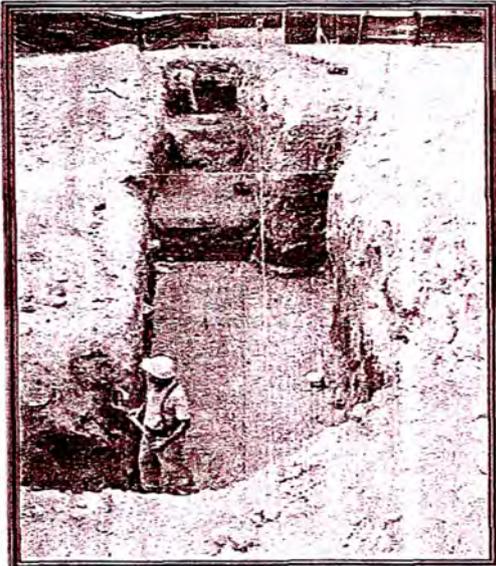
Excavación de zanjas en la zona administrativa.
